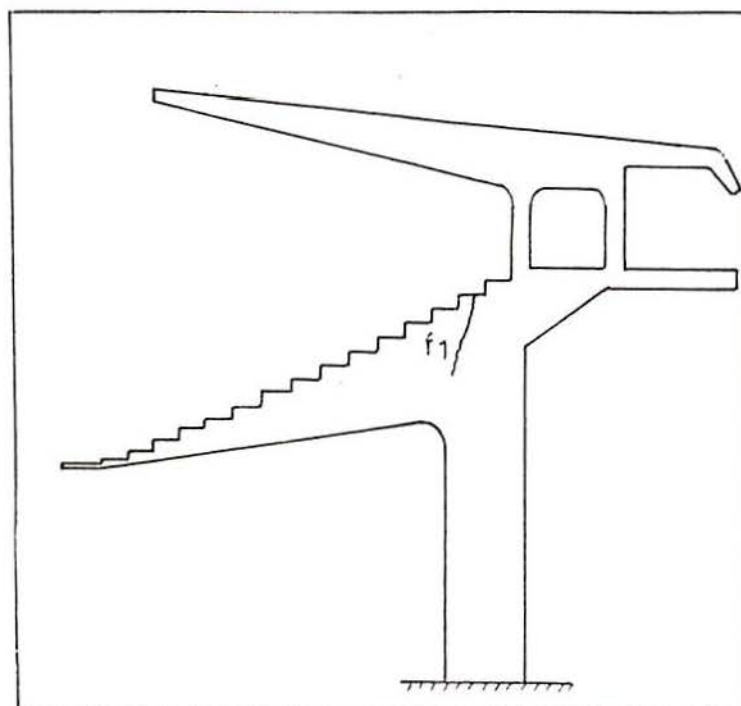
Esquema de fissuras no pórtico 3 para 8 KN.
